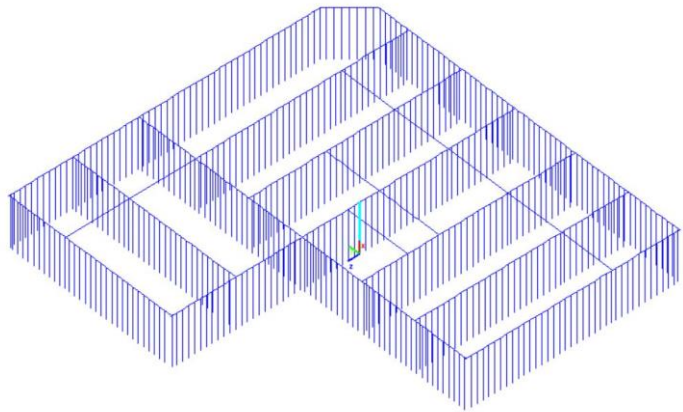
Comprobación de una barra de la estructura en planta baja. Imagen de ANGLE.
